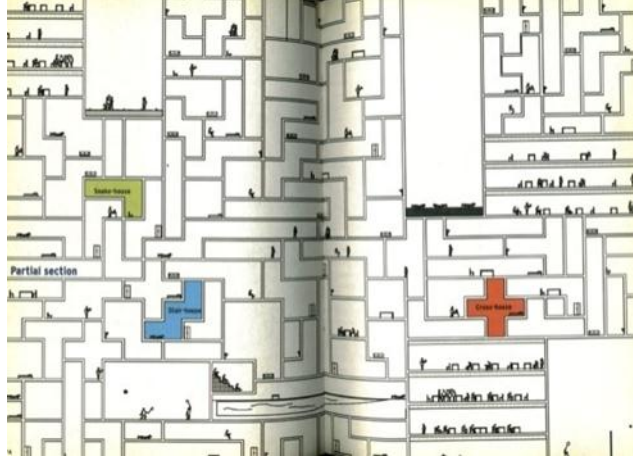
Yerleşimin planından bir detay: konut dokuması ya da konut halısı (MVRDV, 1998).
